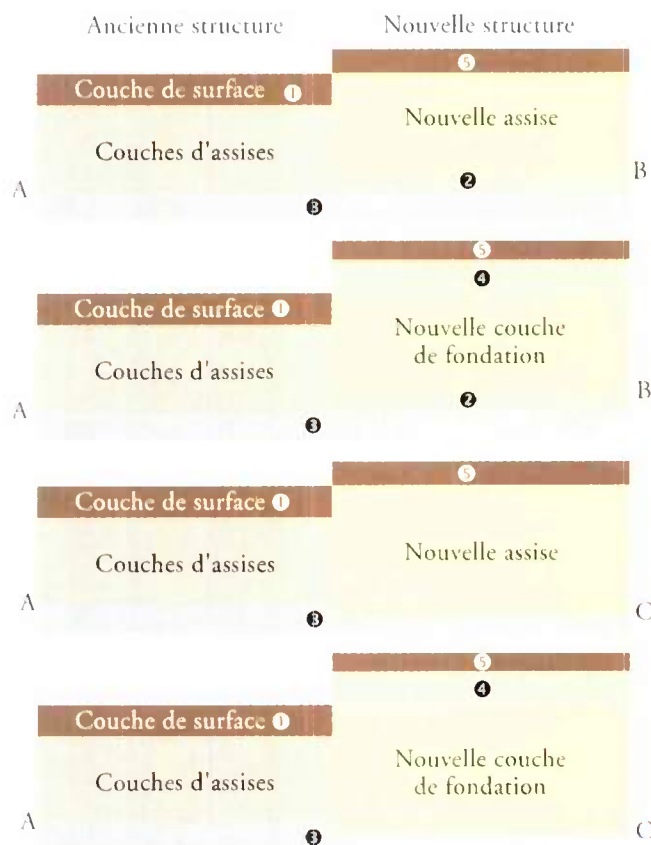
Structures de chaussées obtenues par retraitement. Cas d'un défaut structurel majeur.
